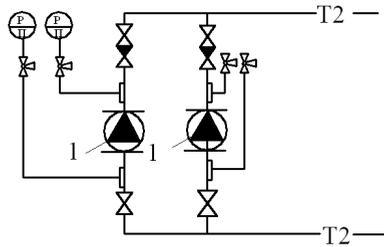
Схеме включения в трубопроводы системы отопления специальных отопительных насосов: 1 – циркуляционный насос
